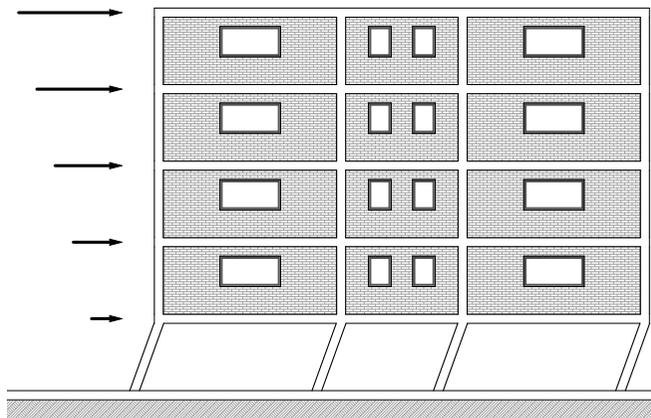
Ejemplo edificio con planta libre en respuesta a un esfuerzo sísmico
